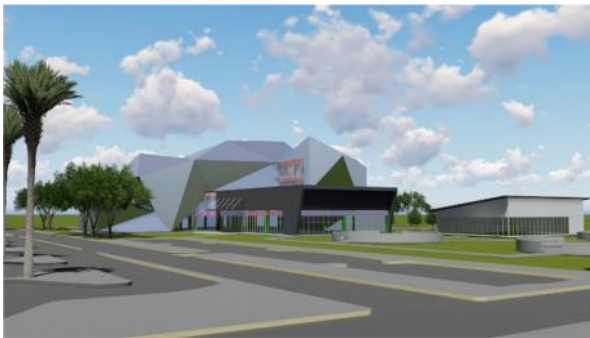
16. Tamapak Depan – Tamapak Belakang Bangunan
